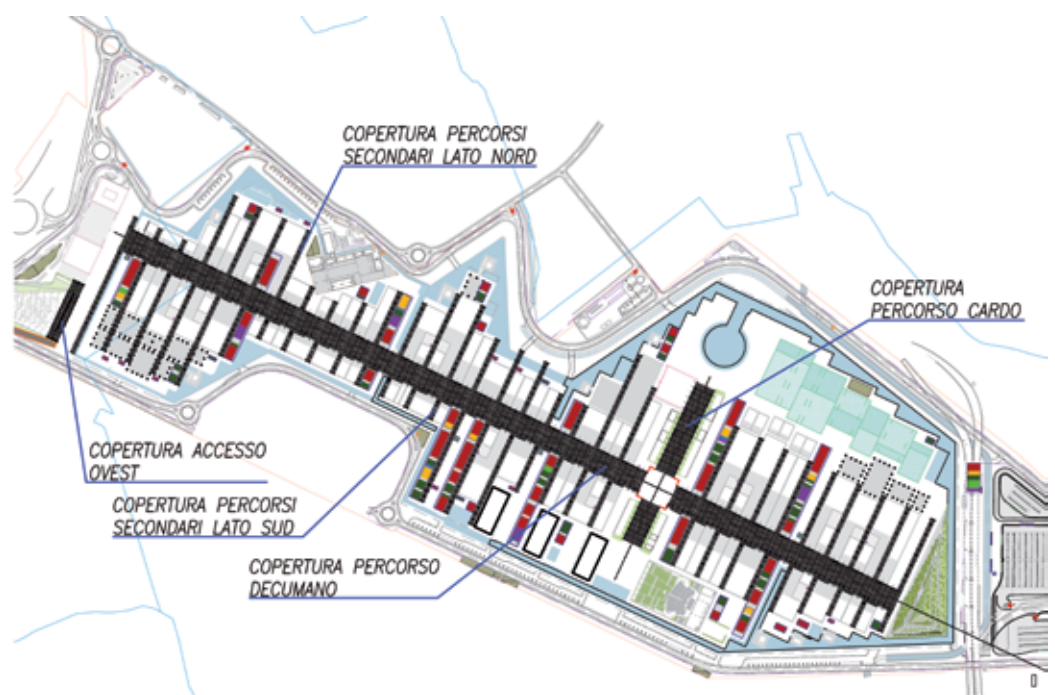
Disposizione in pianta delle strutture di copertura ai camminamenti
